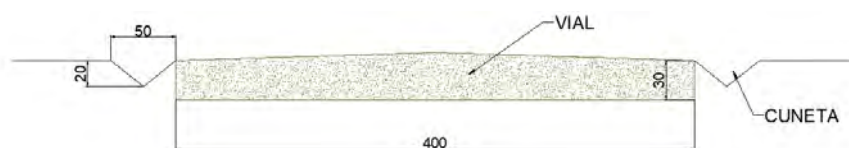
Sección transversal vial secundario (Fuente: propia Elaboración: propia)
